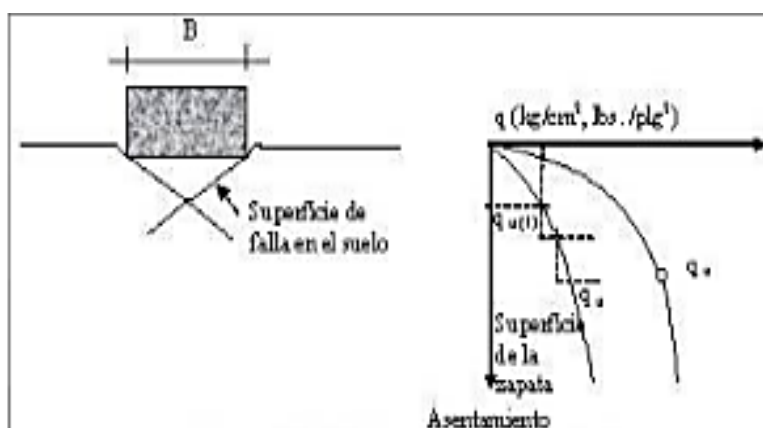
Falla de Corte por Punzonamiento. (Fuente: Vesic, 1973).
